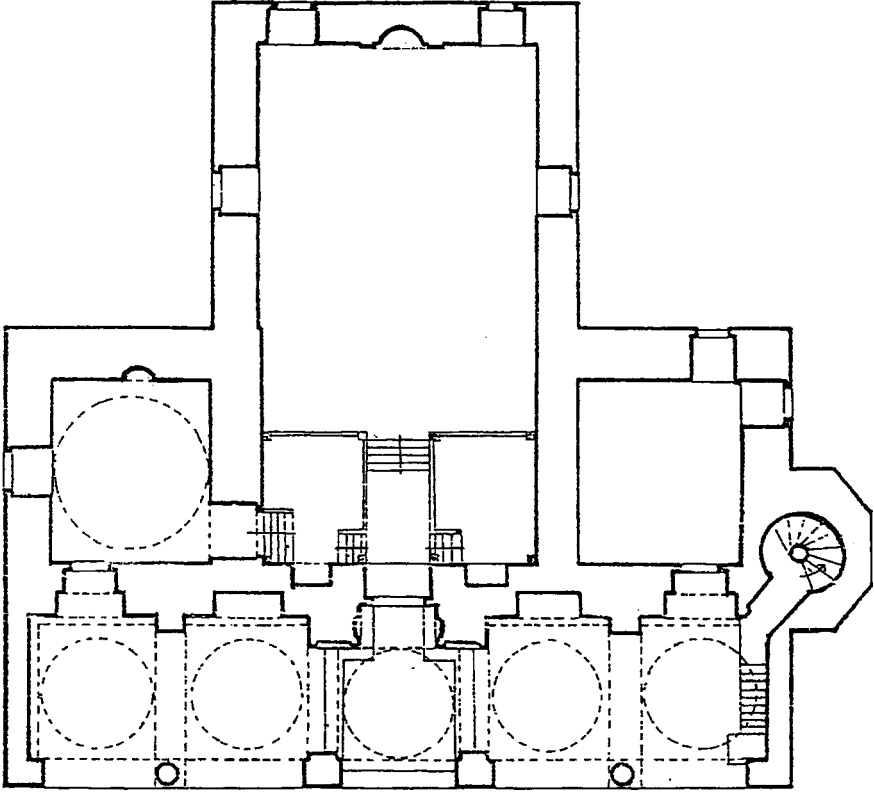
Milas Firuz Bey Camii planı (E.H.Ayverdi'den)
